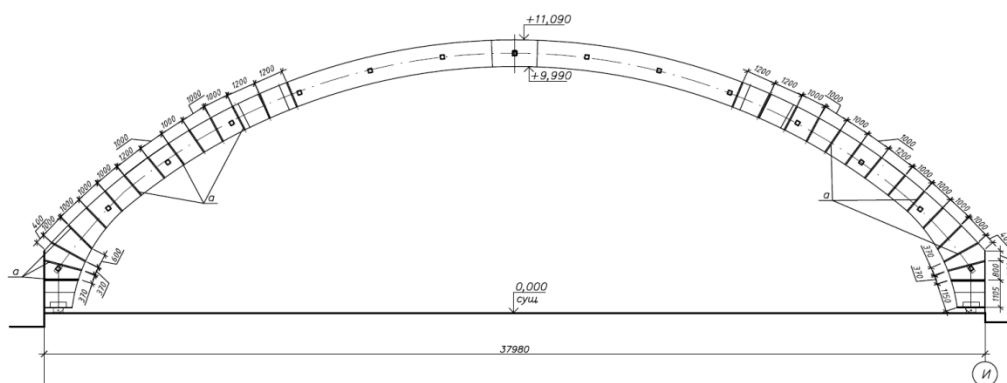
Схема локального усиления углеводволоконными лентами и накладками из LVL
